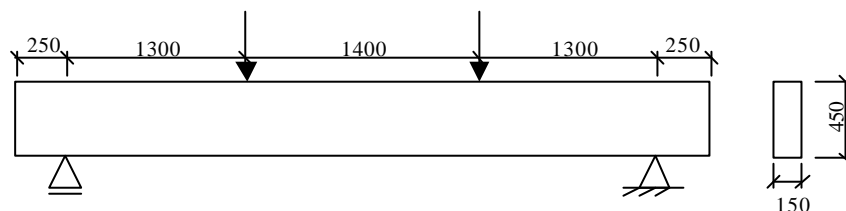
Geometria e carregamento das vigas de Morais (1997).
